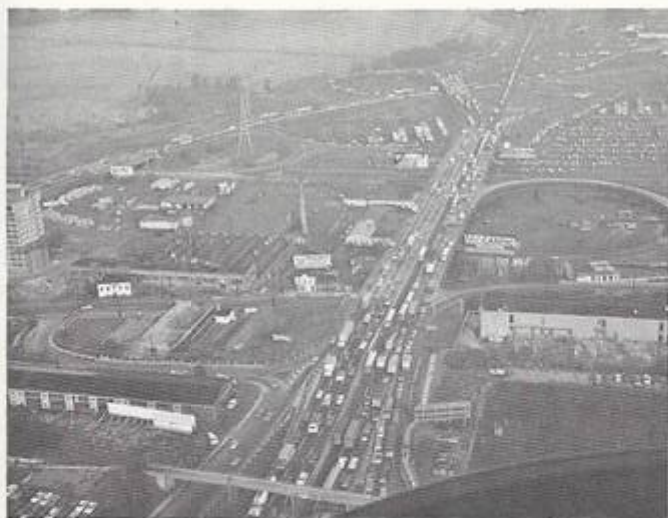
Autoroute Interstate I-495 du New-Jersey à Manhattan : le site propre à contre-sens apparaît très nettement sur cette vue aérienne (photo IRT).
